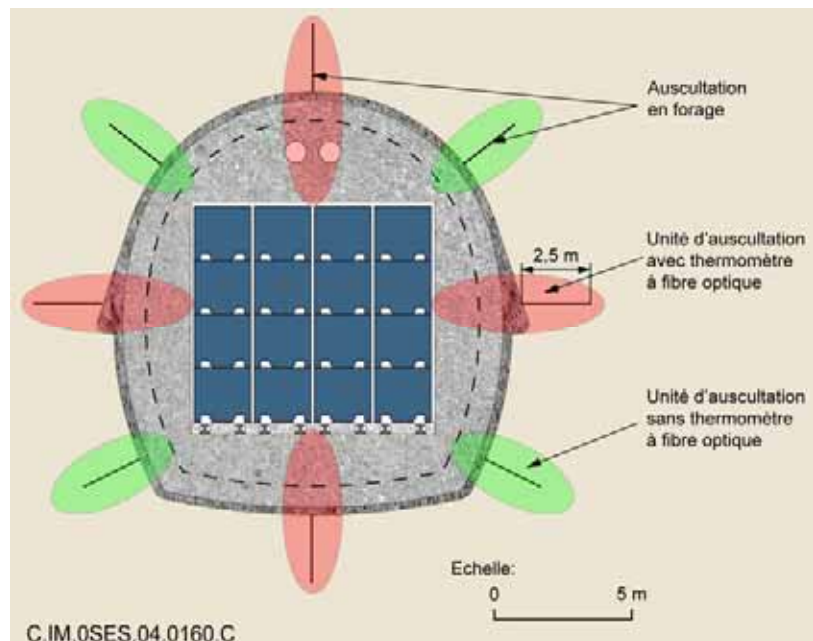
Constitution d'une section instrumentée d'un module B témoin
